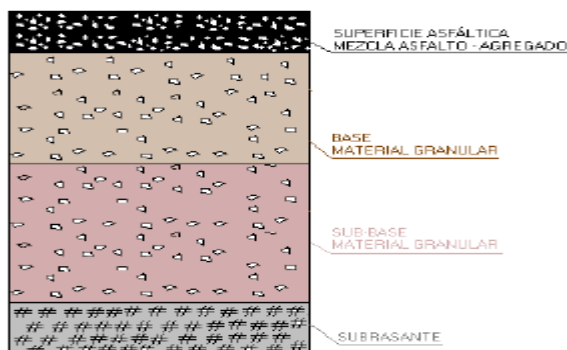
Componentes de un Pavimento Flexible Fuente: Manual Centroamericano Diseño Pavimentos
